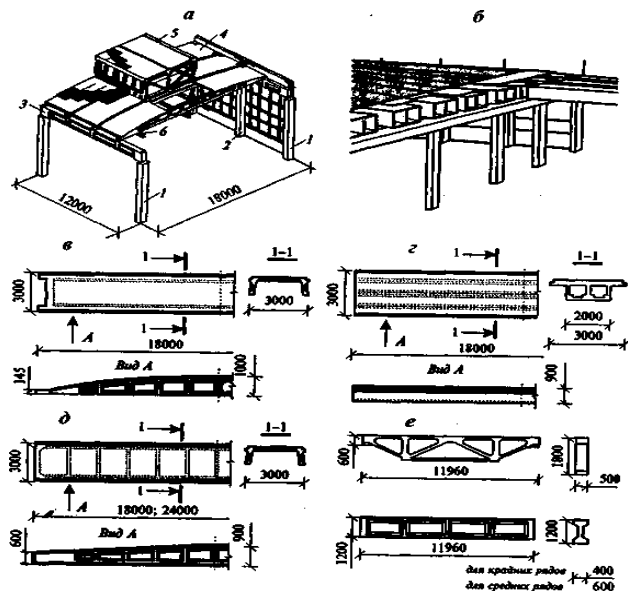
Конструкции покрытия с плитами «пролет»:
